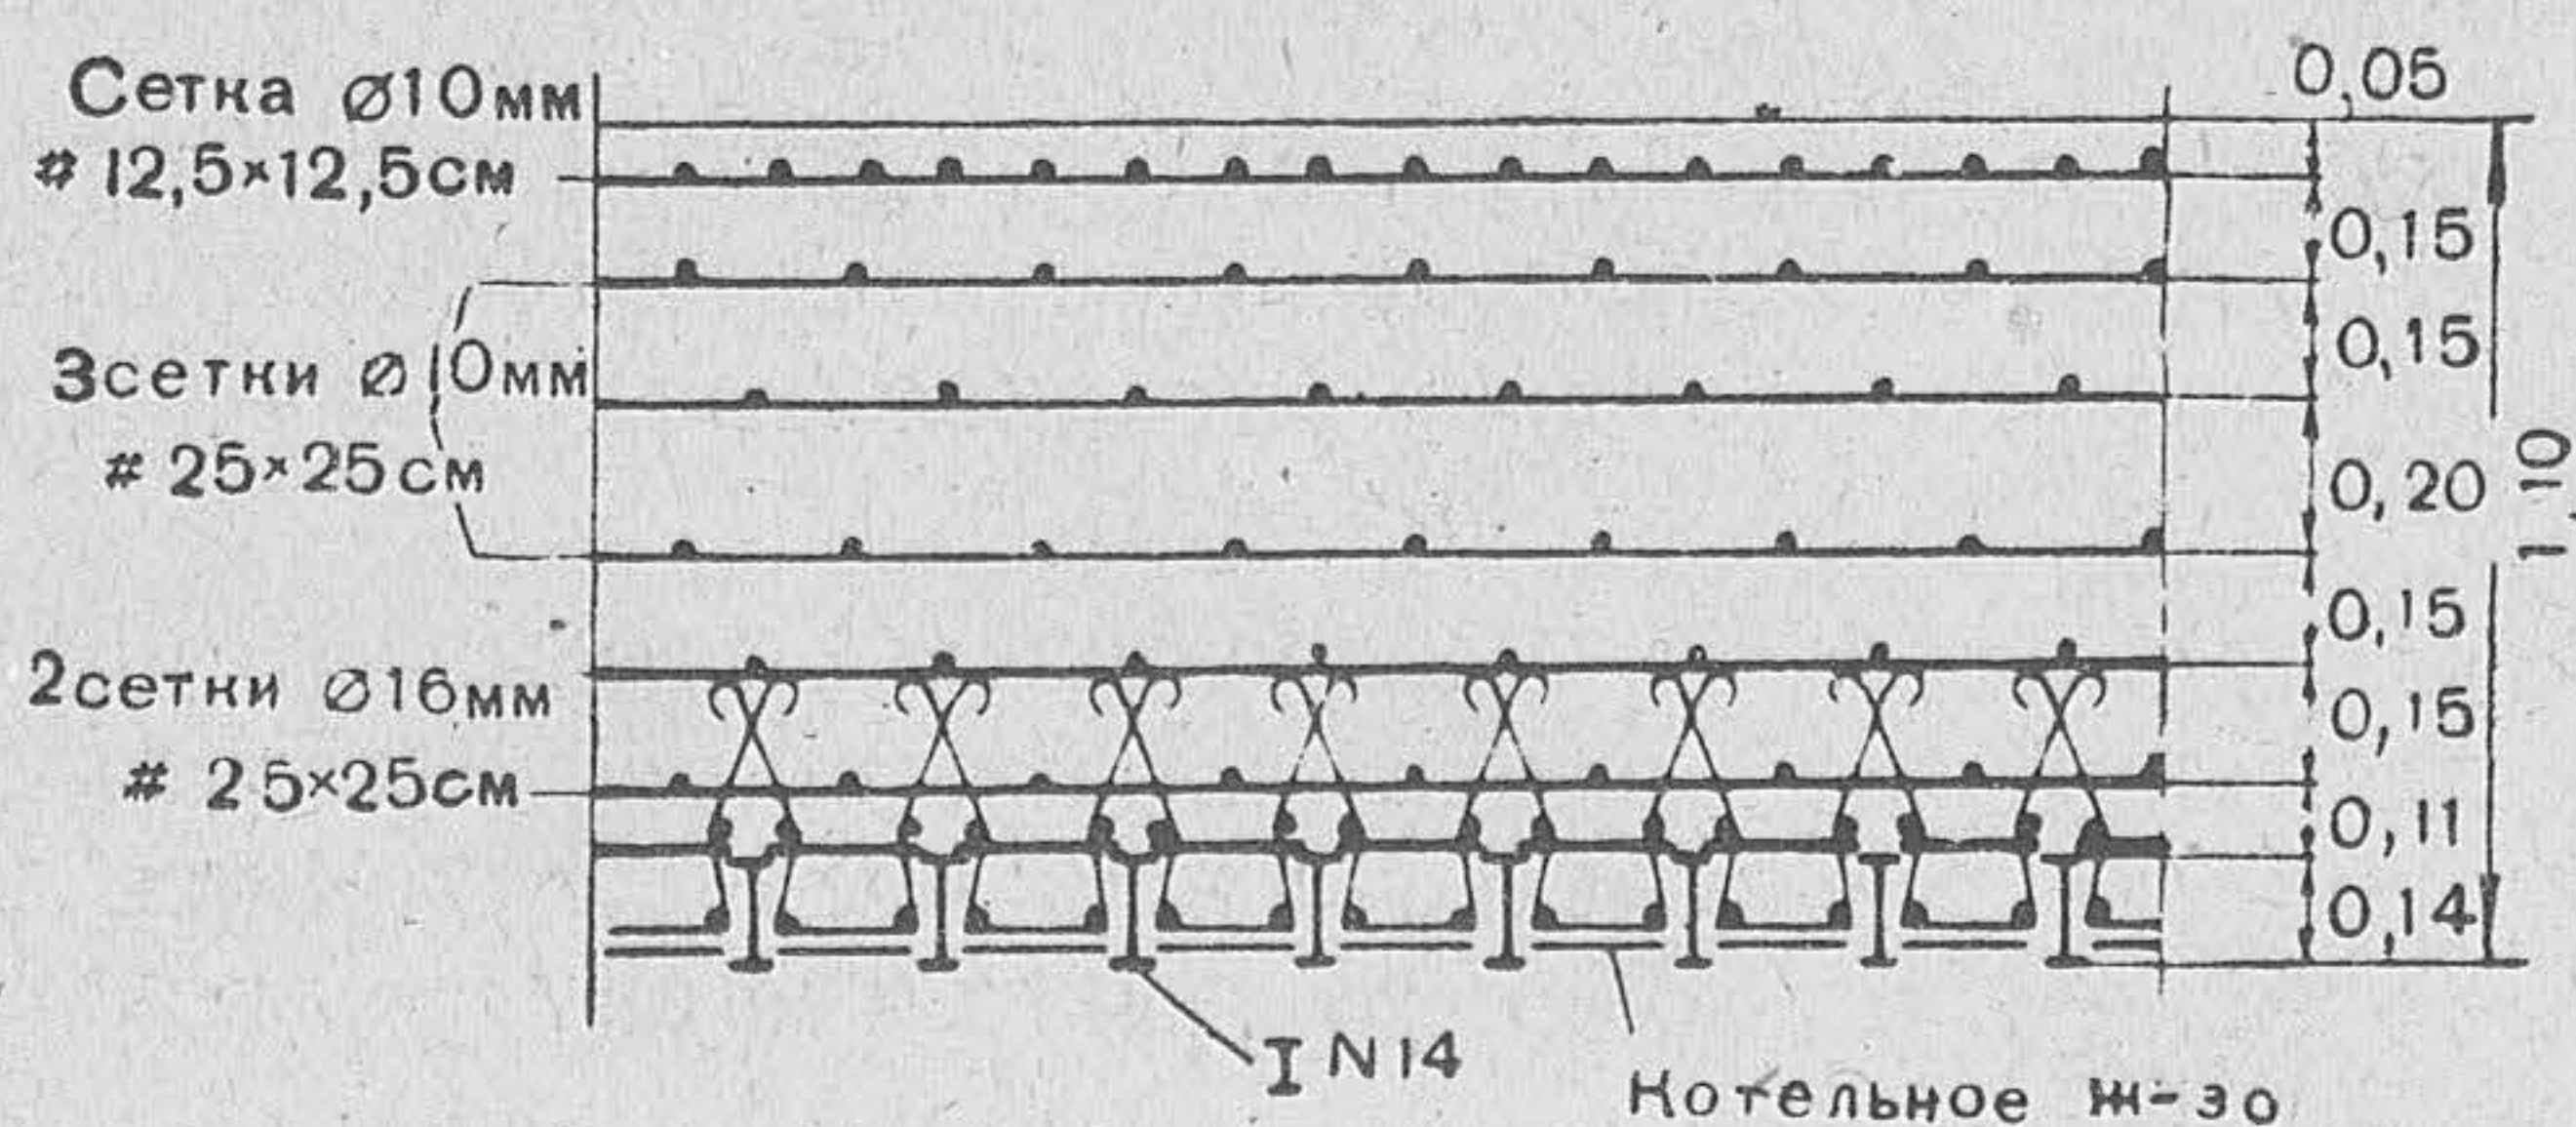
Армирование покрытия тяжелого железобетонного сооружения
